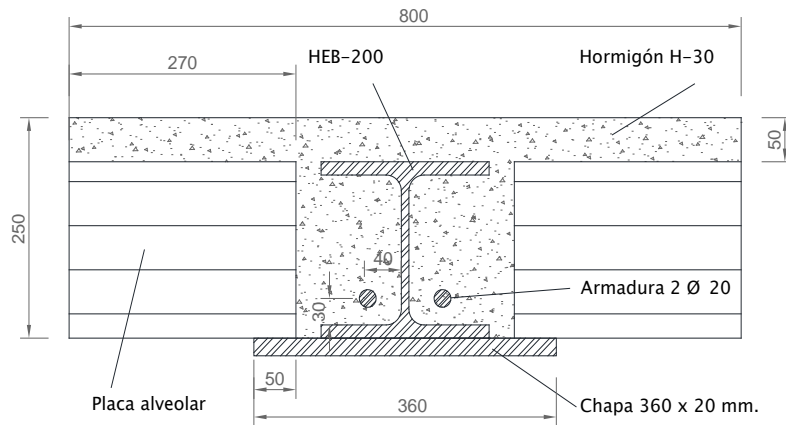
Sección de la viga A2. Tipo SFB. (cotas en mm)
